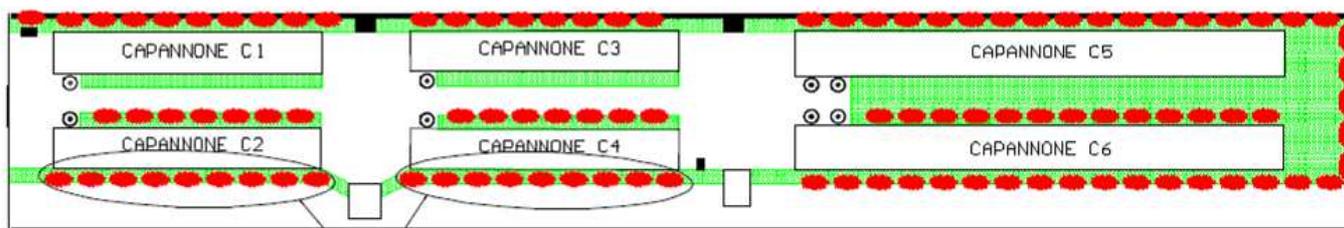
piantumazione dell'allevamento in rosso (fonte: A. I. A.)
